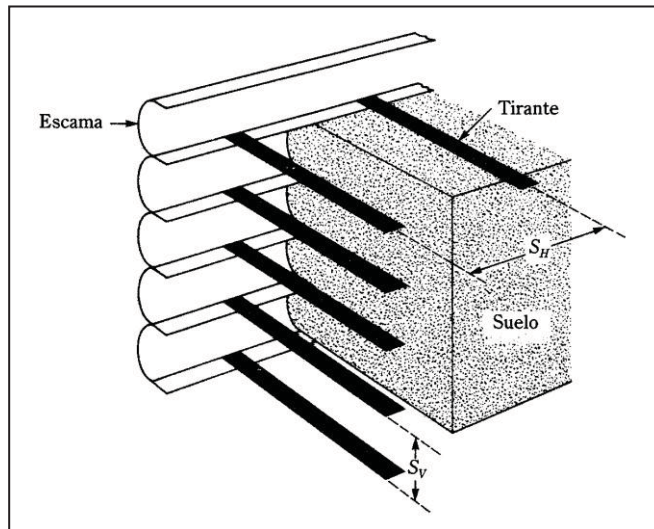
Muros de tierra reforzada con tiras metálicas. (Fuente: Braja M. Das, 2001, pág. 443).
